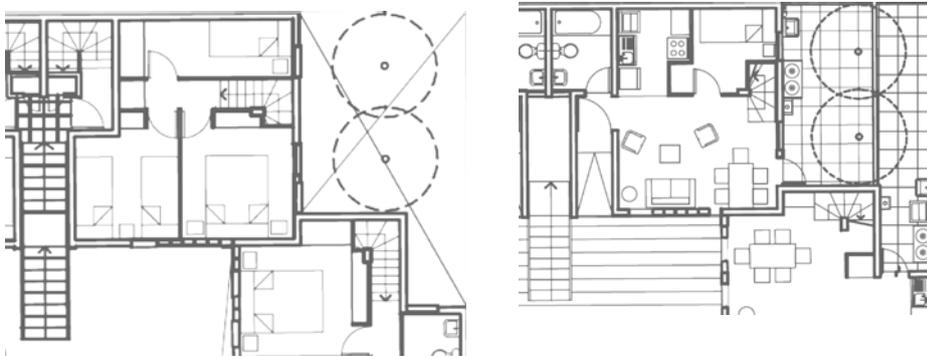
Planta de otra de las viviendas de dos niveles de Neo Cité, esta opción cuenta con un tercer dormitorio.
